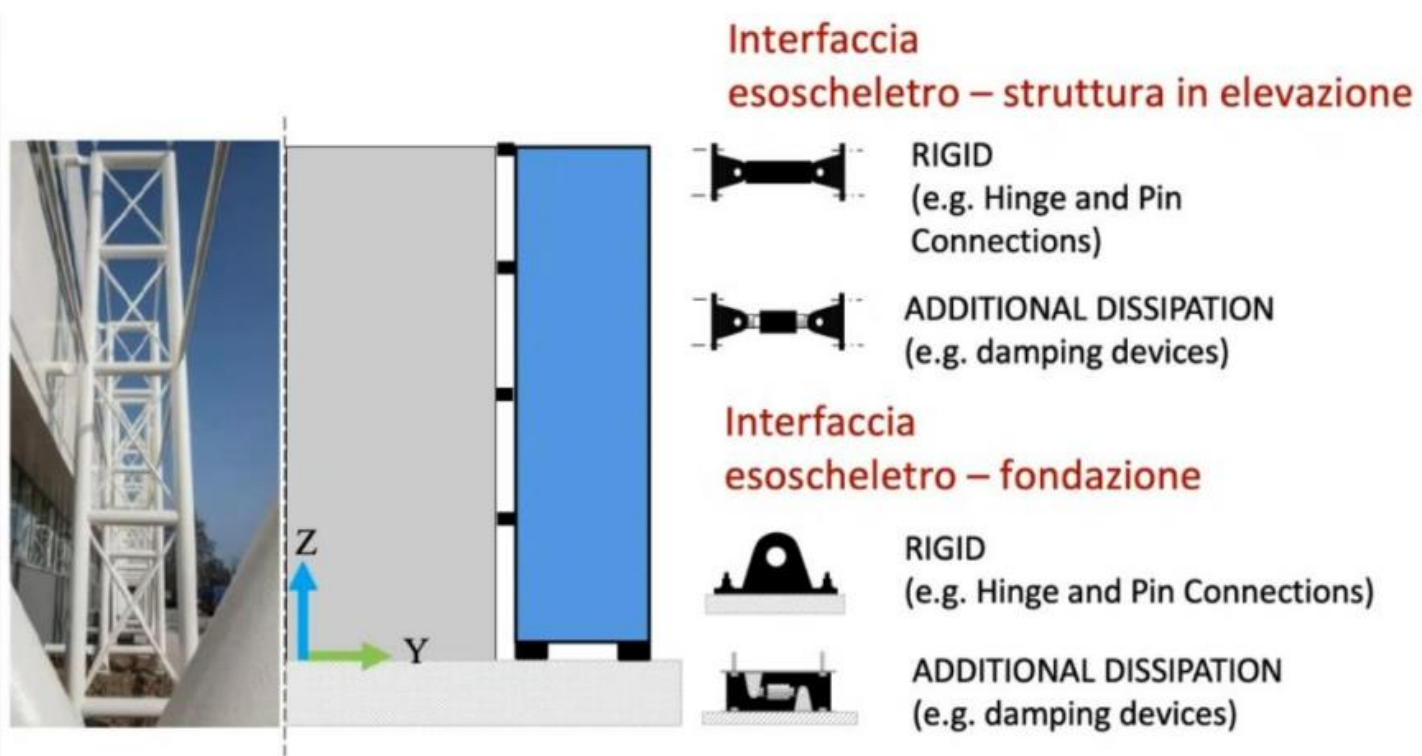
Interfaccia esoscheletro con struttura in elevazione e fondazione
